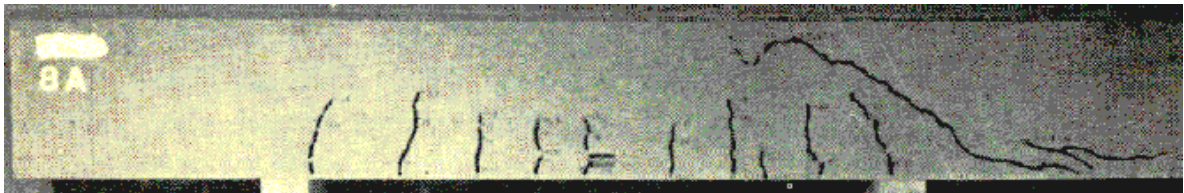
Viga sem armadura de cisalhamento que atingiu a ruptura no momento da primeira fissura inclinada (Hanson, 1958)
